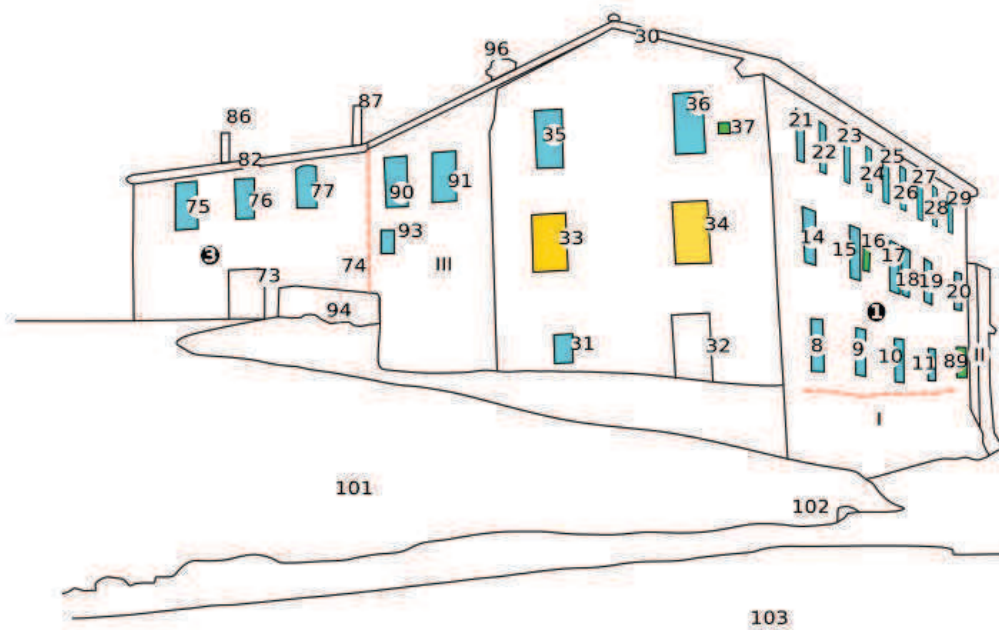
Croquis de la leyenda de elementos de la fachada.
